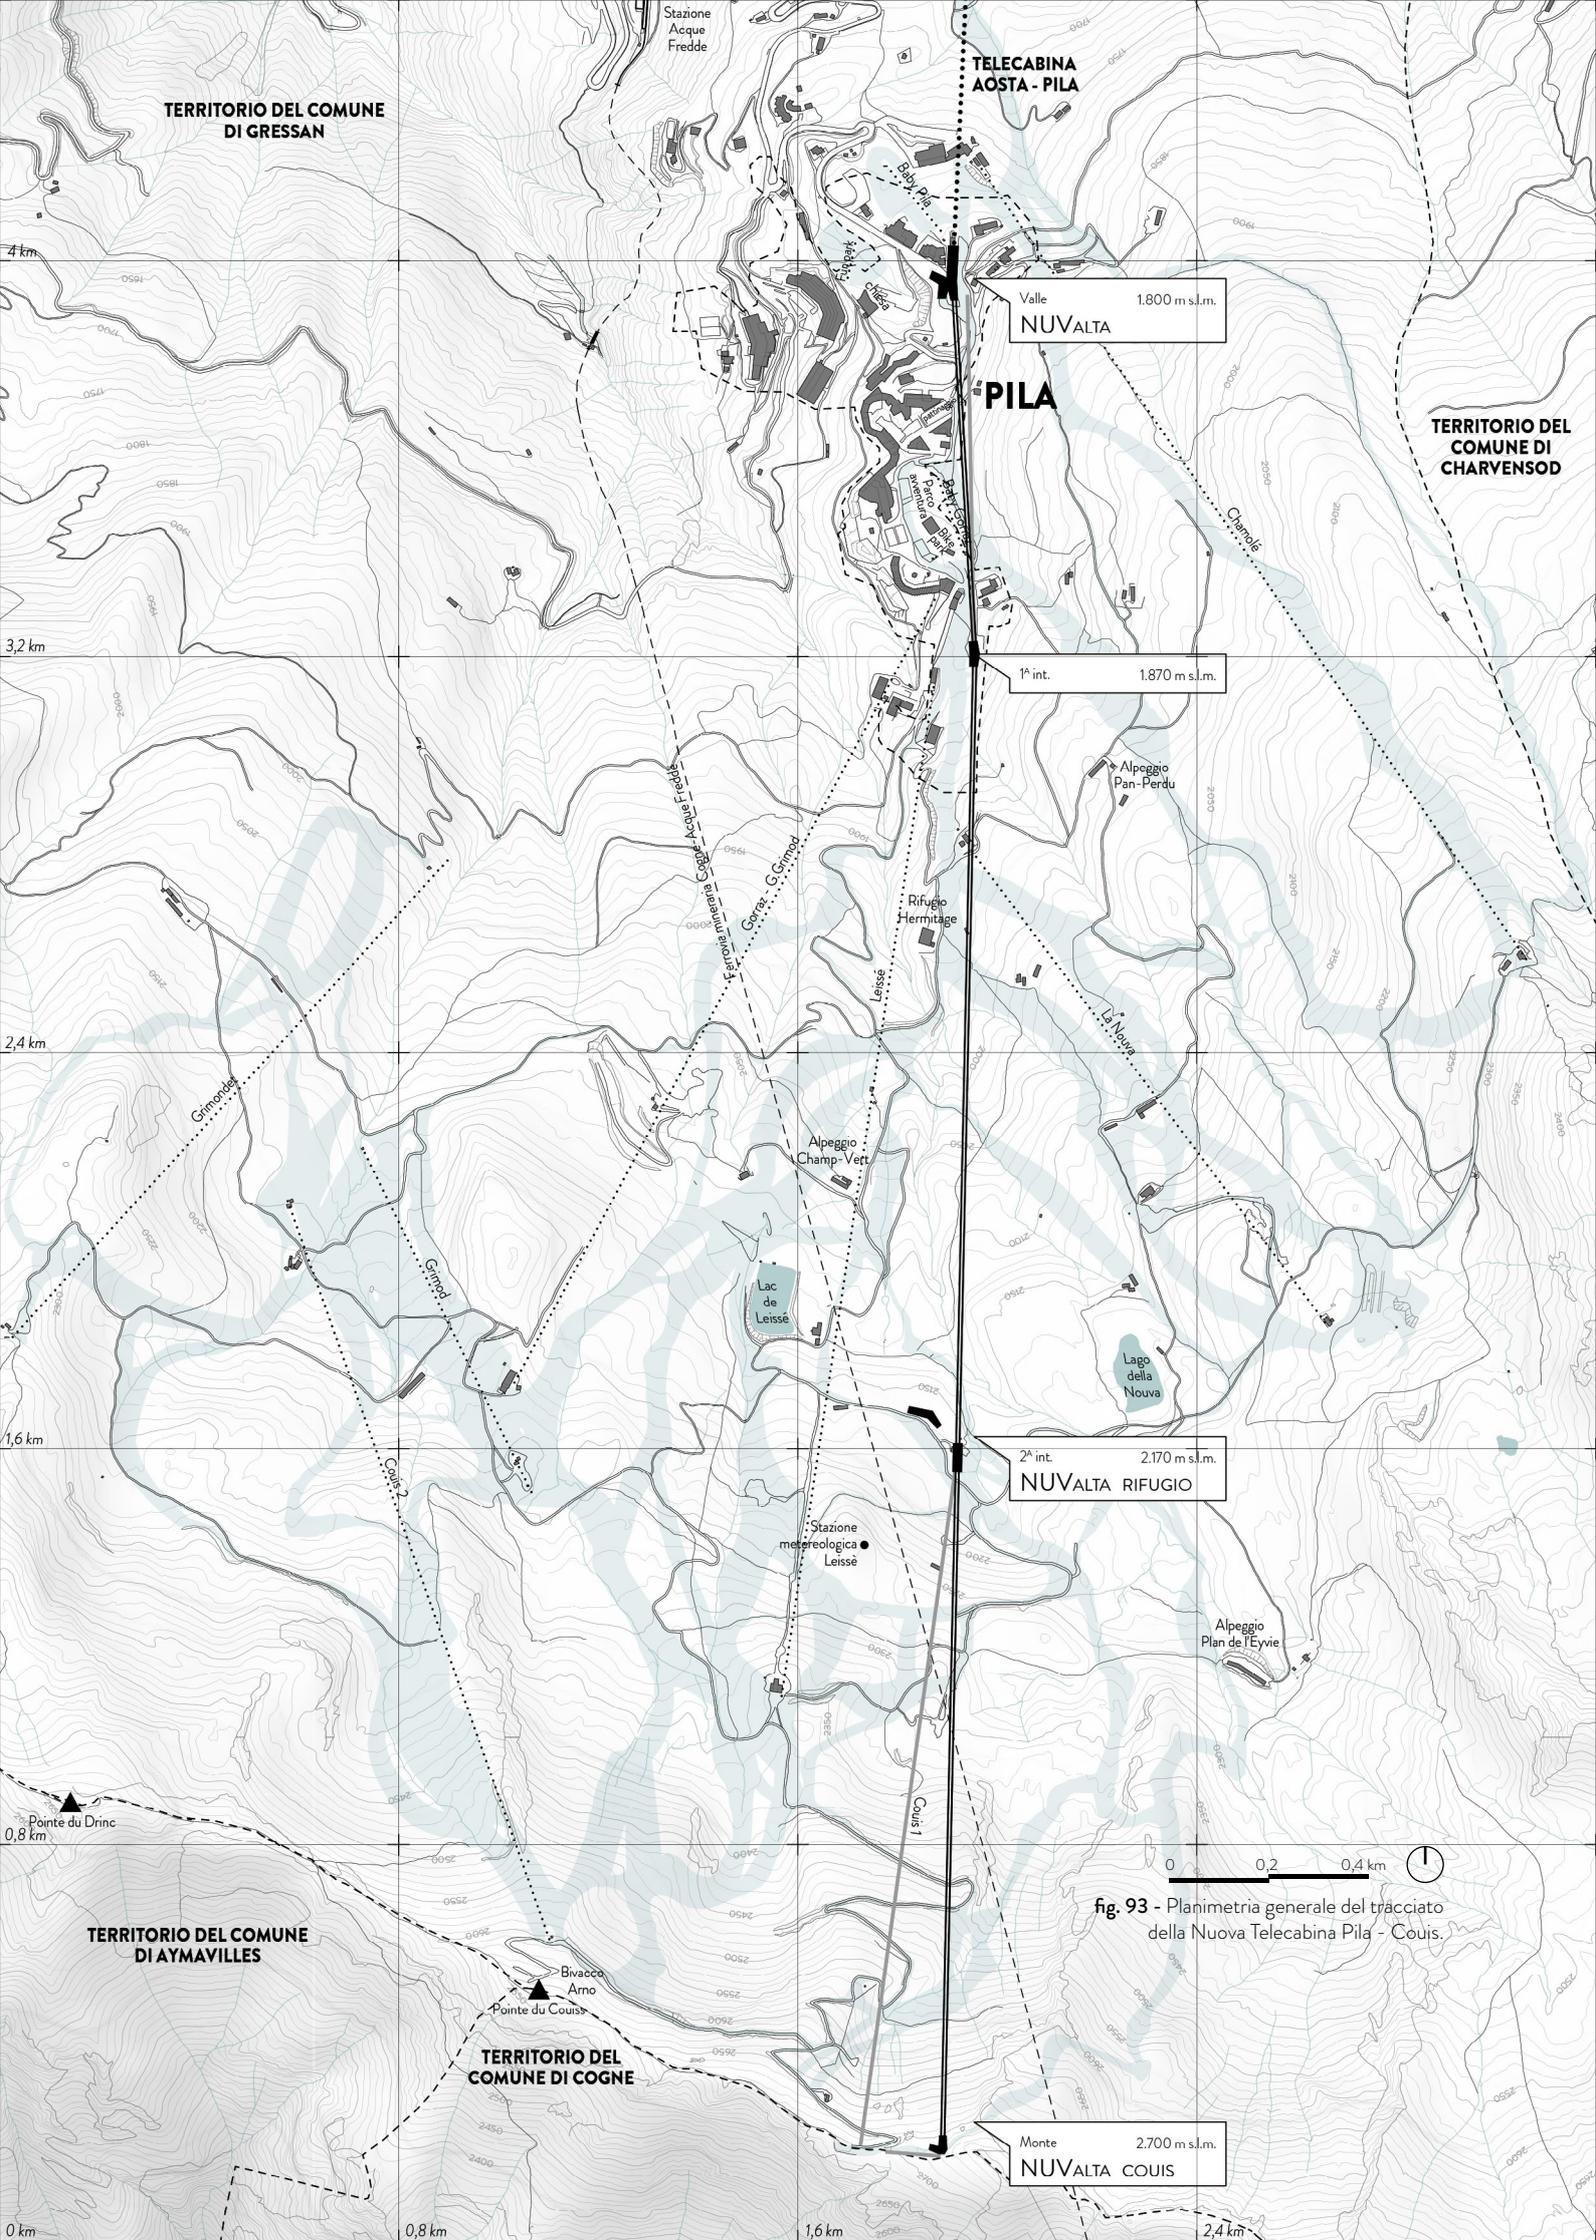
Planimetria generale del tracciato della Nuova Telecabina Pila - Couis.
